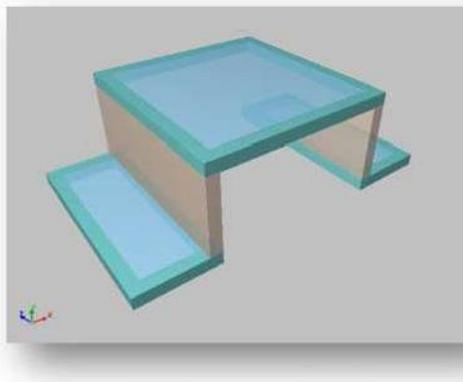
Esquema referencial de estructuración cajón de protección Gasoducto. Losa superior desmontable.
